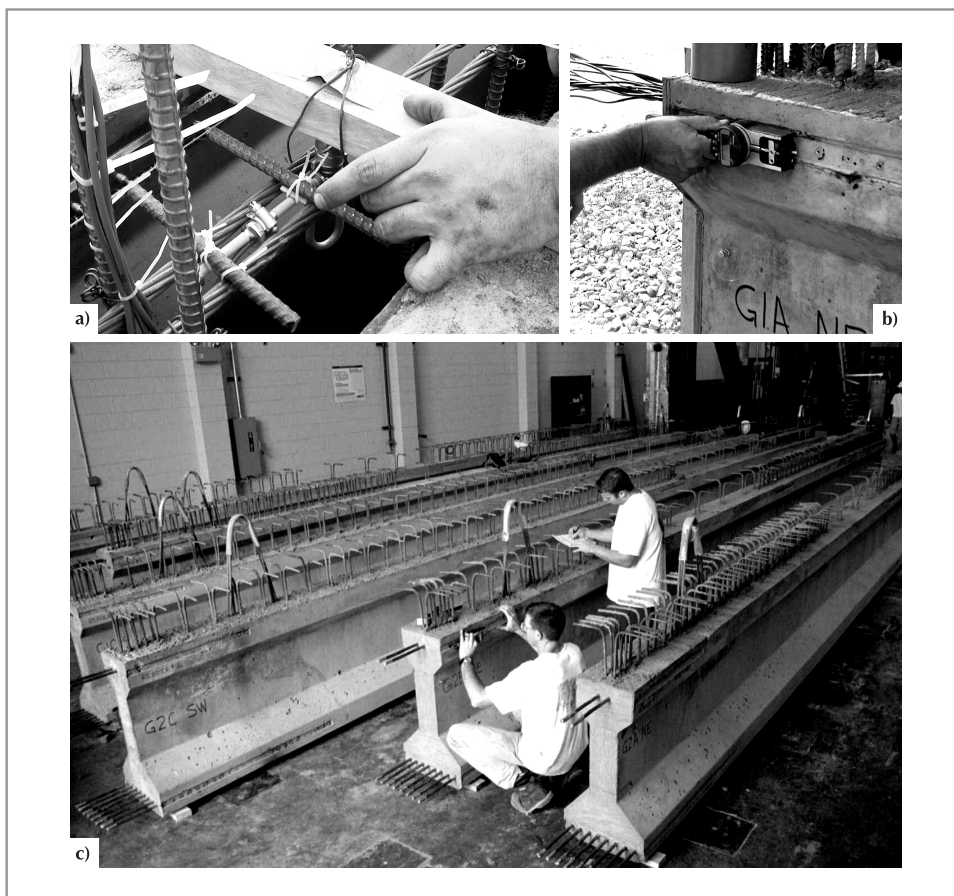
(a) Deformómetro de cuerda vibrante embebido en las vigas pretensadas; (b) deformómetro DEMEC e insertos; (c) medición de deformaciones en vigas pretensadas
